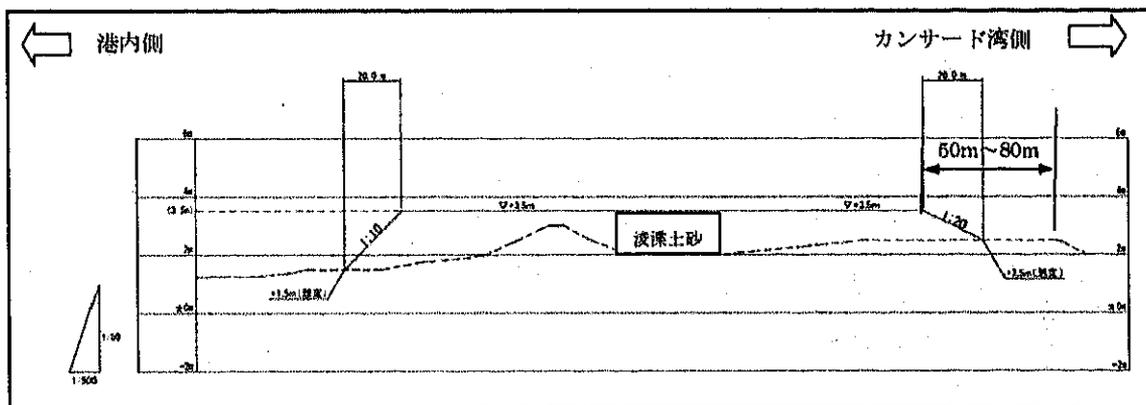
(12) 浚渫土砂の敷き均し C-C 断面図
